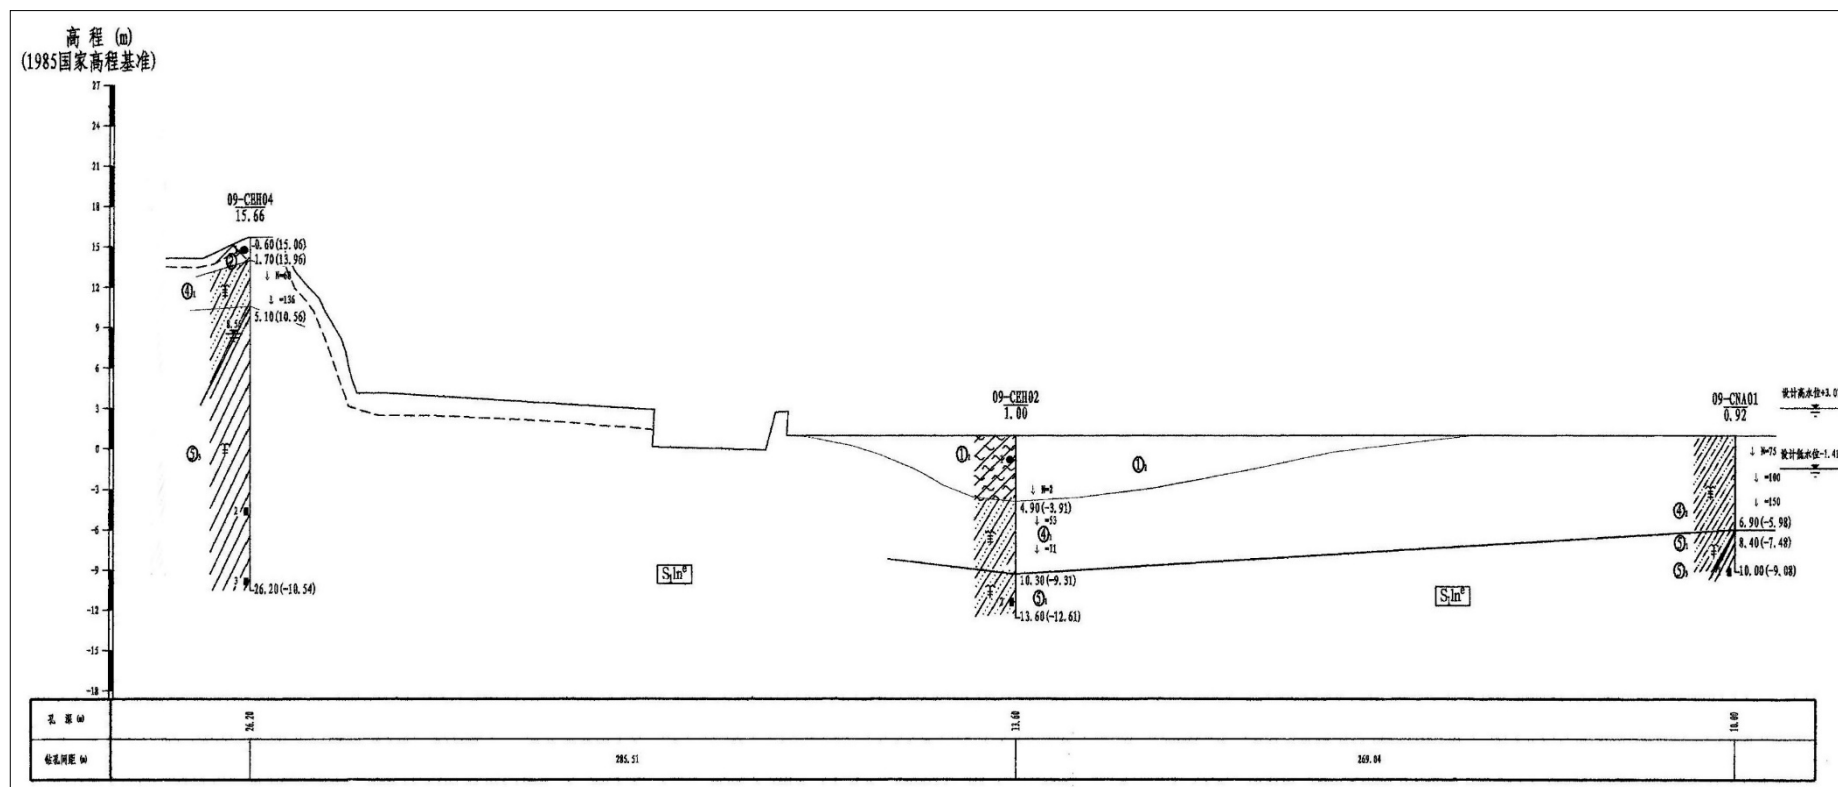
地质剖面图 (B14-B14' 剖面节选)
